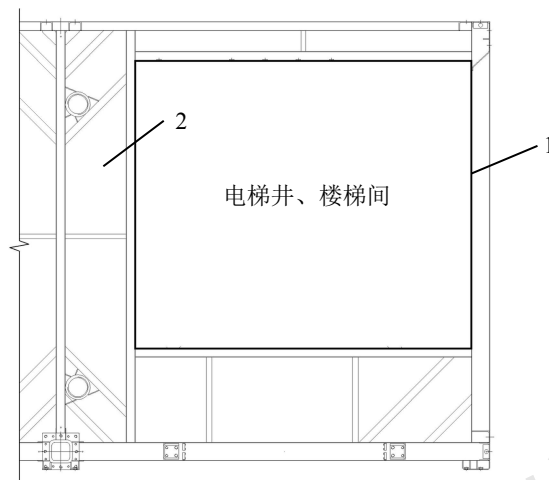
电梯井和楼梯穿越集成楼盖处四周的防火分隔构造平面示意图
